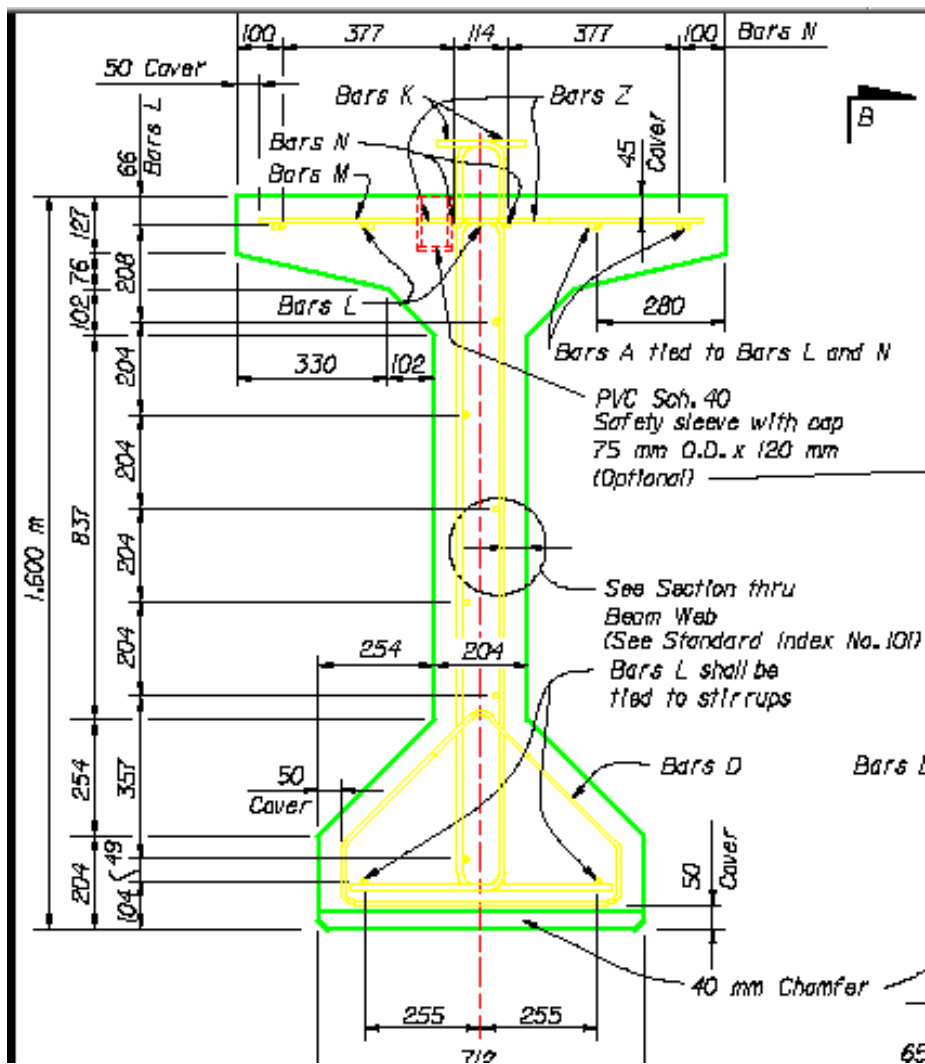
LAS ARMADURAS CONSTRUCTIVAS FUERON SACADAS DE LAS ESPECIFICACIONES, AASHTO
